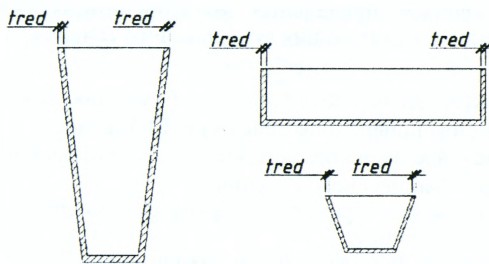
Схемы приведения легких СЖБ балок к бетону
